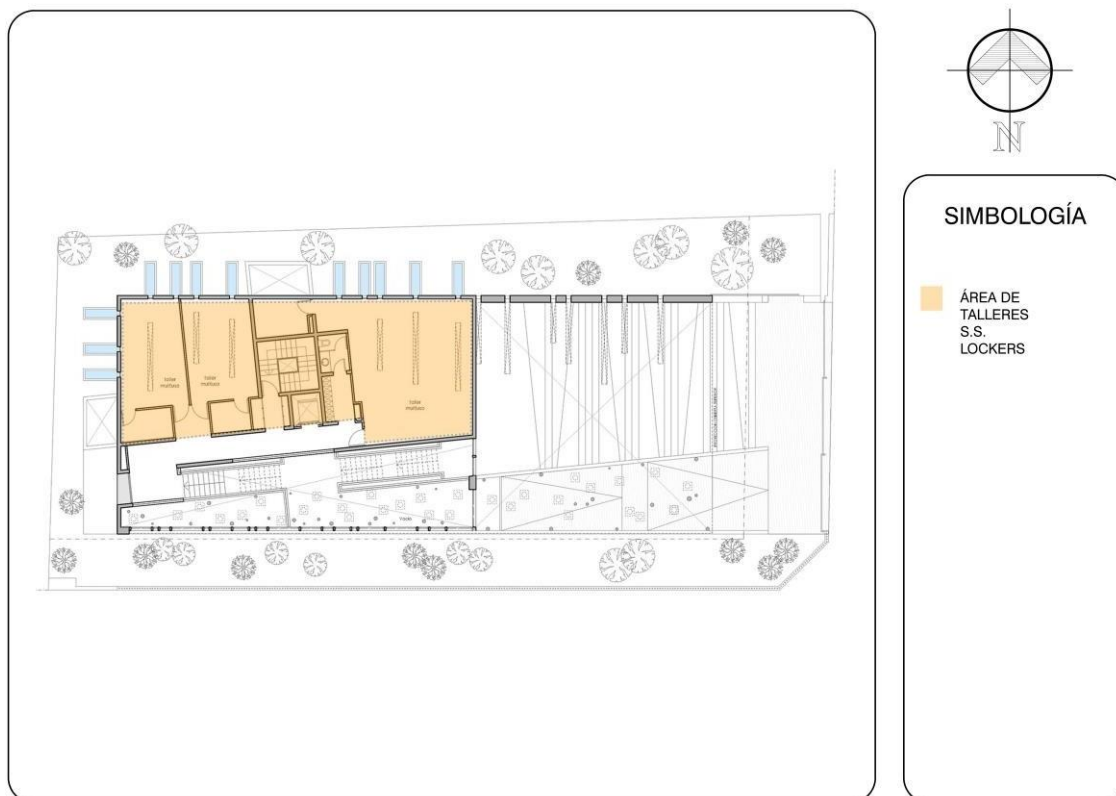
Planta Alta Fuente: Elaboración propia a partir de planos Proyecto Centro de las Tradiciones
